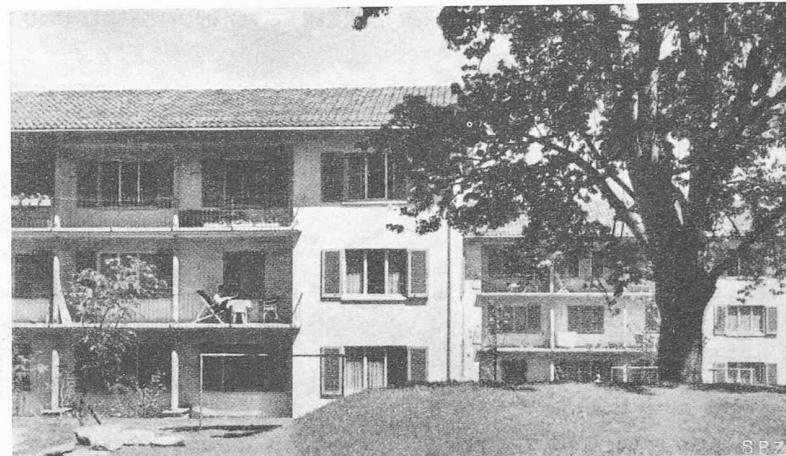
(Westseite) und Bild 4 (Grundrisse 1 : 300) der dreigeschossigen Mehrfamilienhäuser an der Butzenstrasse in Zürich 2, erbaut 1945. Arch. M. ZOLLINGER
